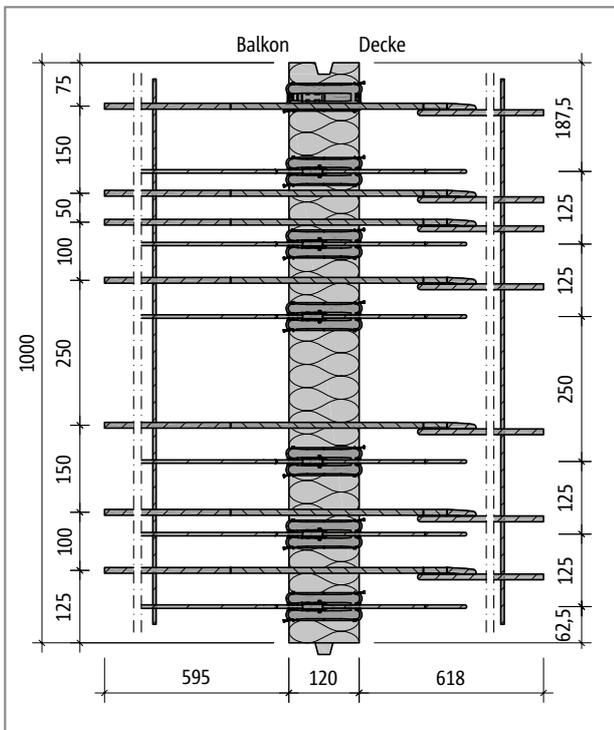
Schöck Isokorb® Typ KXT30-HV: Produktgrundriss
